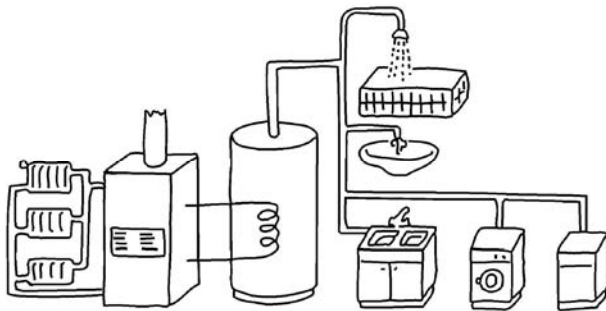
Heizungsanlage mit Warmwasserspeicher
